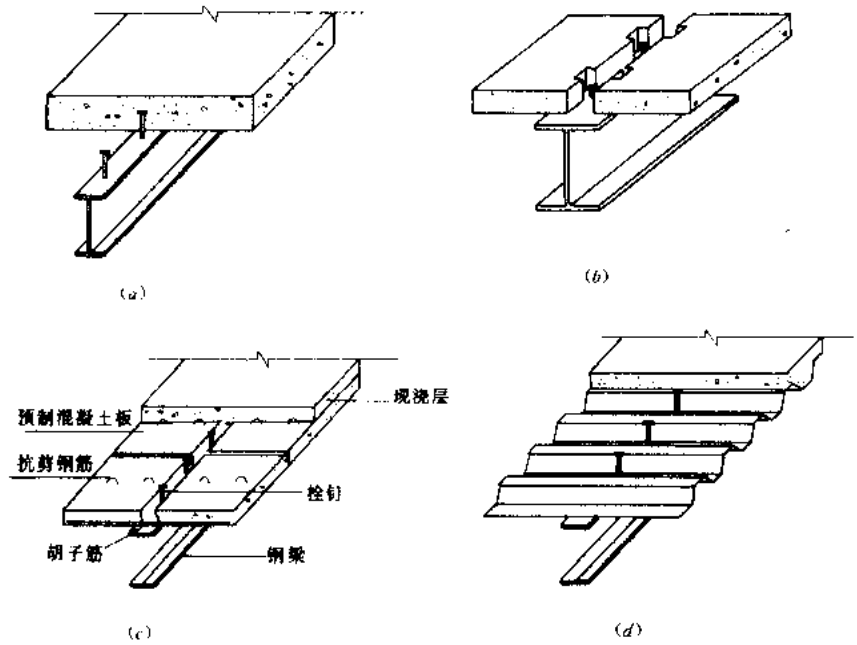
不同混凝土翼缘的钢-混凝土组合梁截面形式
